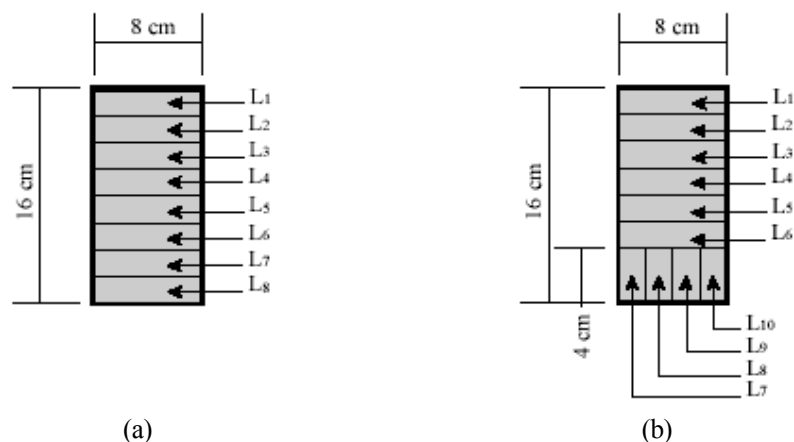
(a) Lote II - vigas laminadas horizontalmente e (b) Lote III – vigas laminadas multidirecionalmente.
